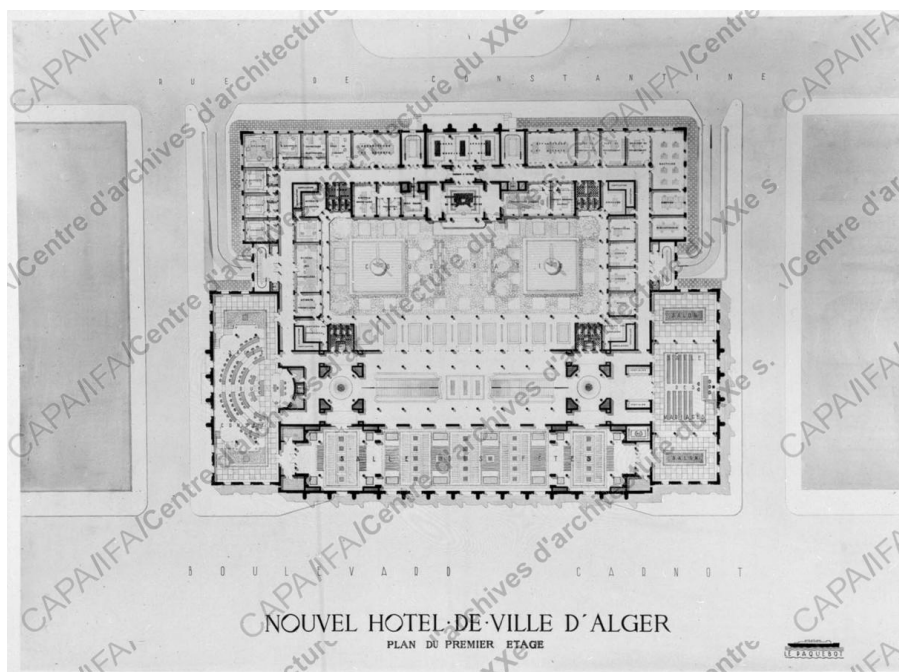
24 : Plan général du nouvel Hôtel de ville
